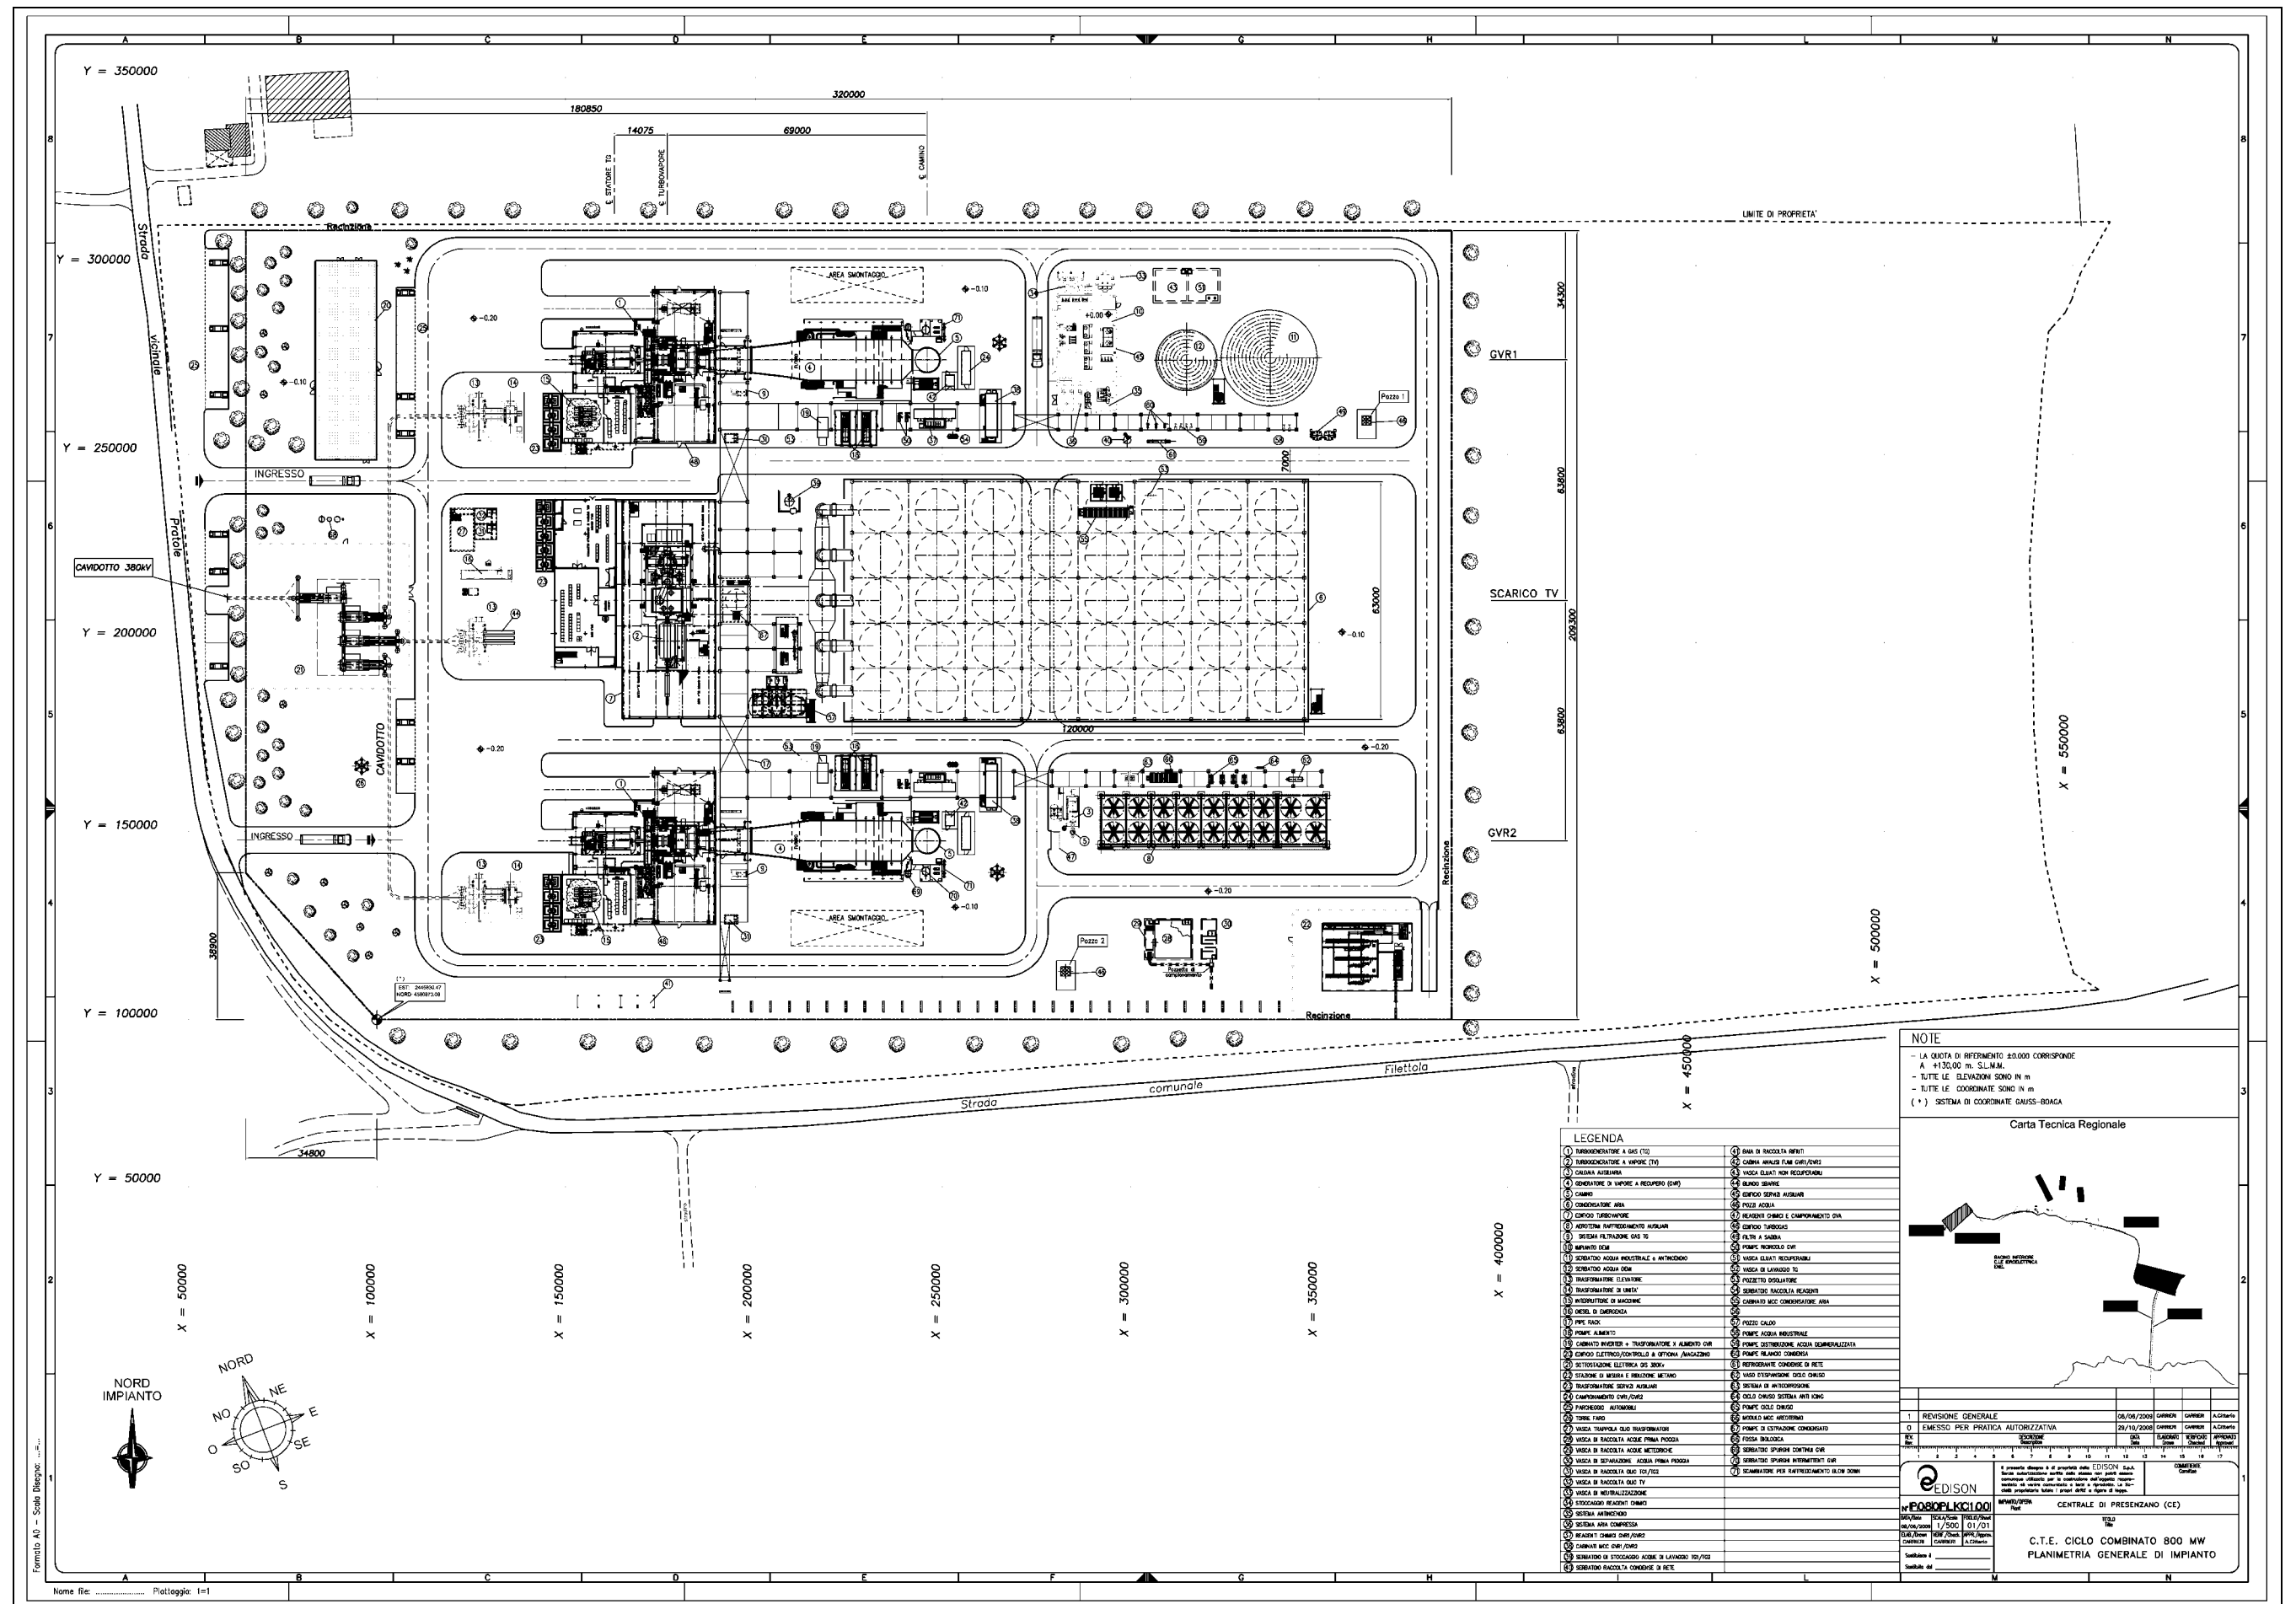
Planimetria della Centrale (Fonte Edison, 2009)
